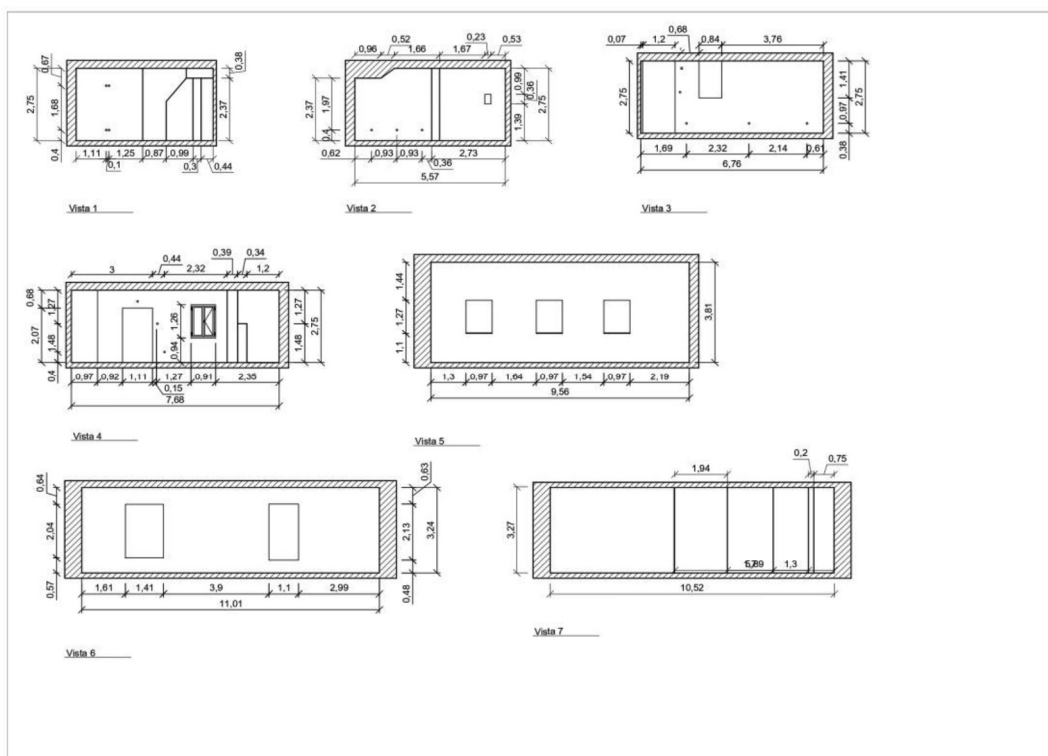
Vistas do existente, sem escala. Fonte: o Autor
